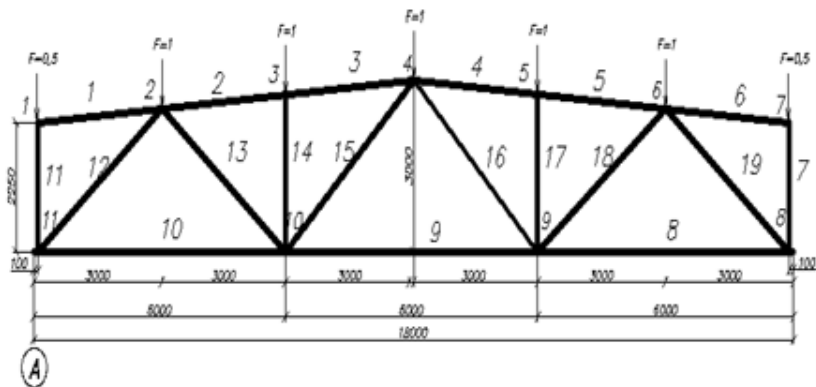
Геометрическая схема фермы в осях поясов и элементов решётки при расчёте от единичных нагрузок.
